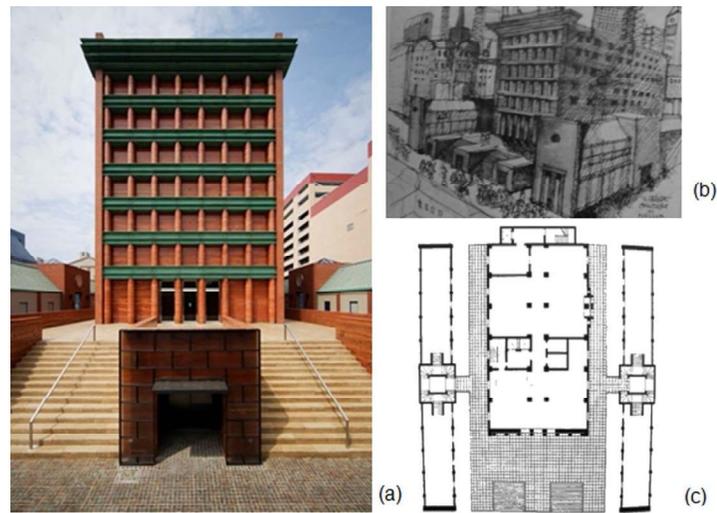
Aldo Rossi, Hotel en Fukuoka, Japón, (1987-1989): (a) Vista exterior fachada principal, (b) Boceto a tinta, (c) Planta Baja.
